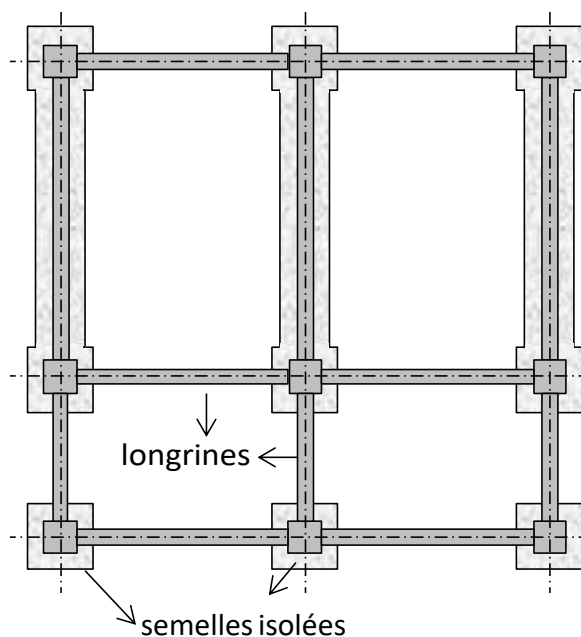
exemple de liaisonnement des fondations isolées par longrines
